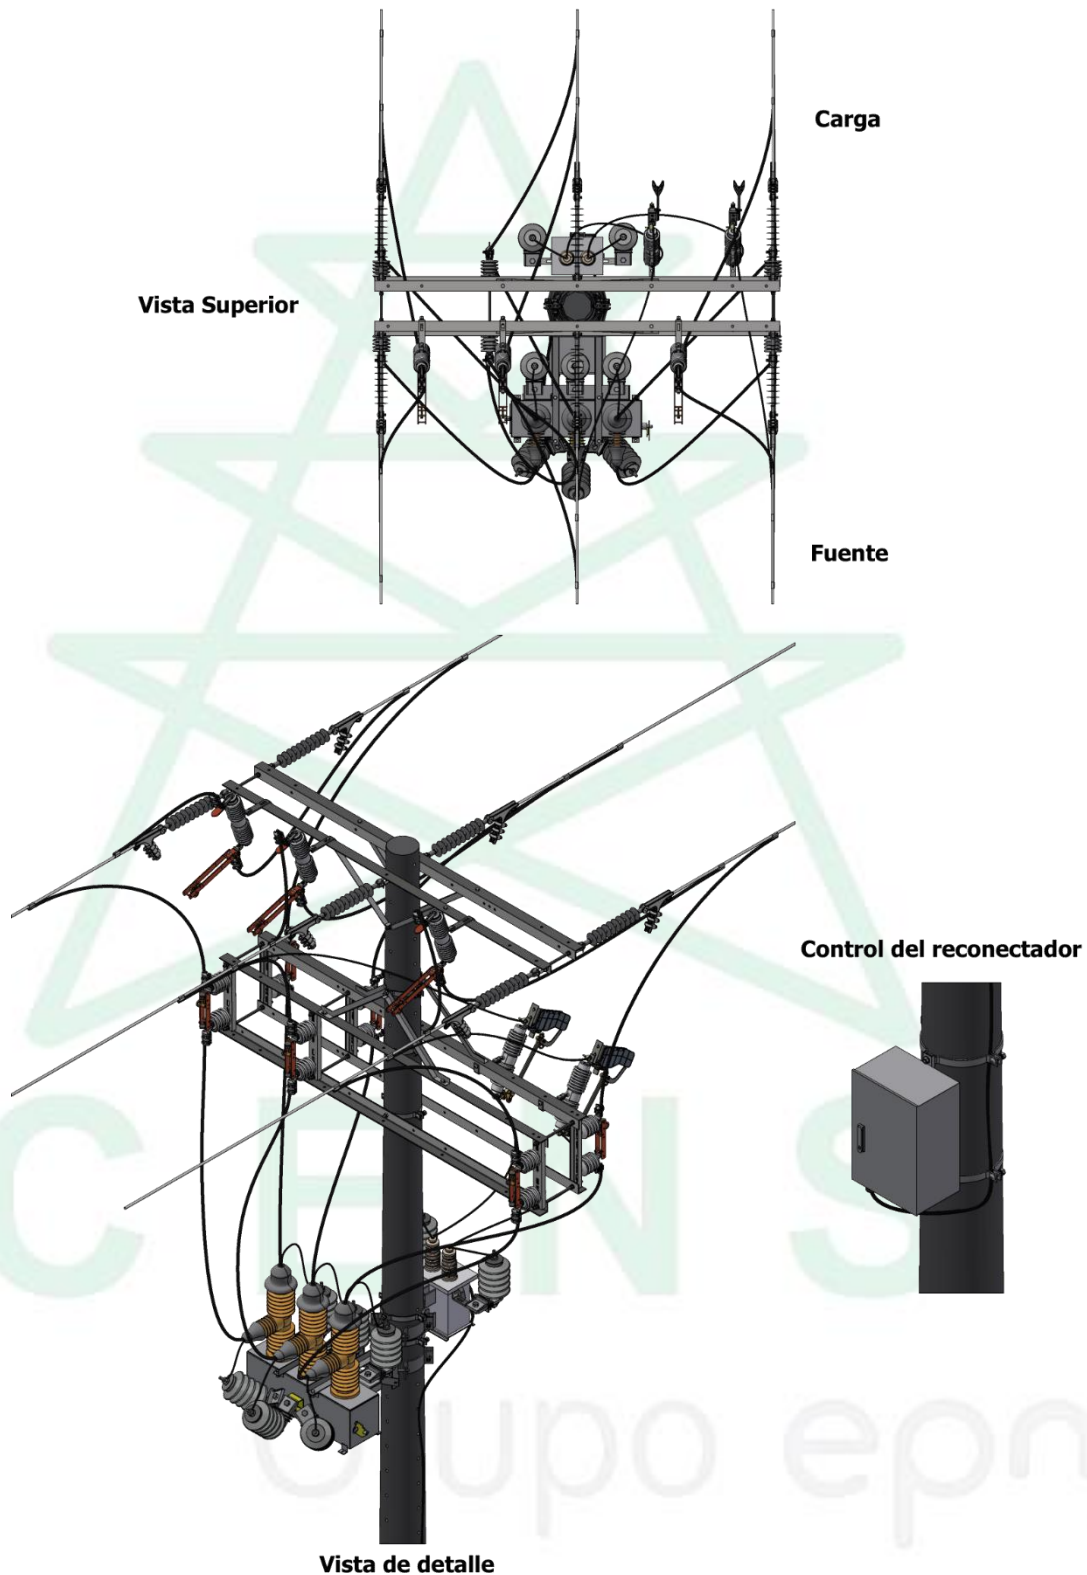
Dimensiones de montaje reconector 34.5 kV horizontal
